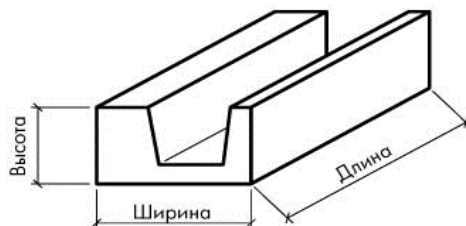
Внешний вид и размеры U-образных блоков.
